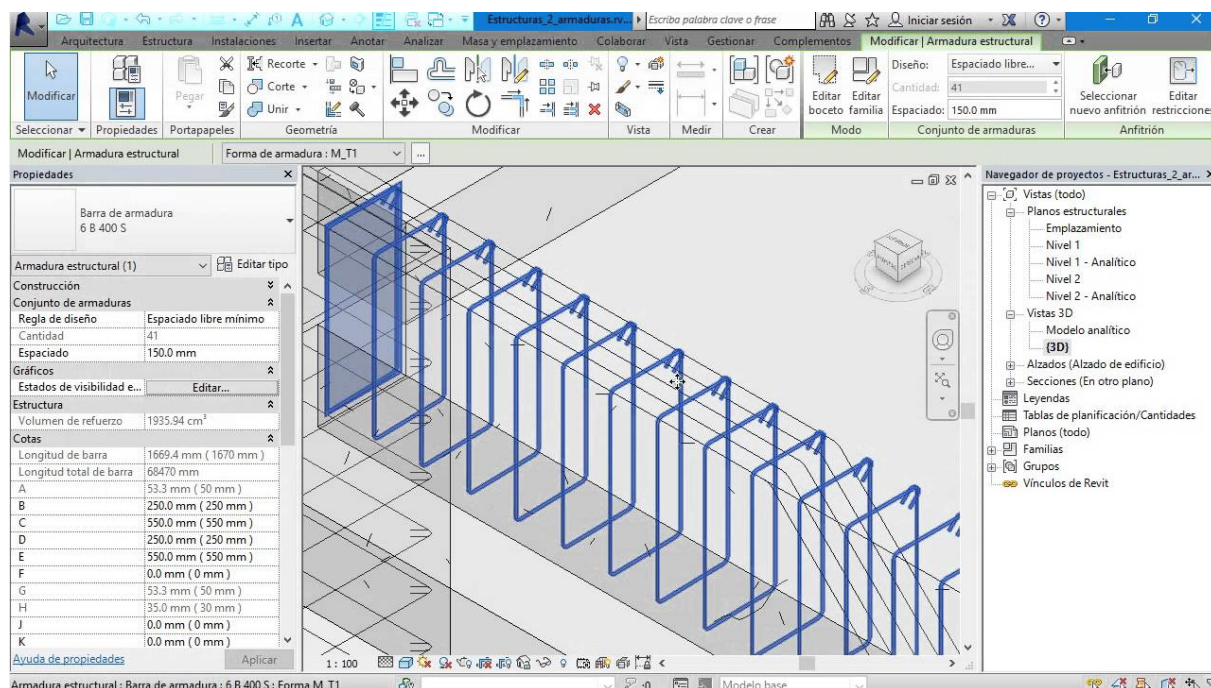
Captura de proyecto ejecutado sobre la plantilla estructural de Revit®.
